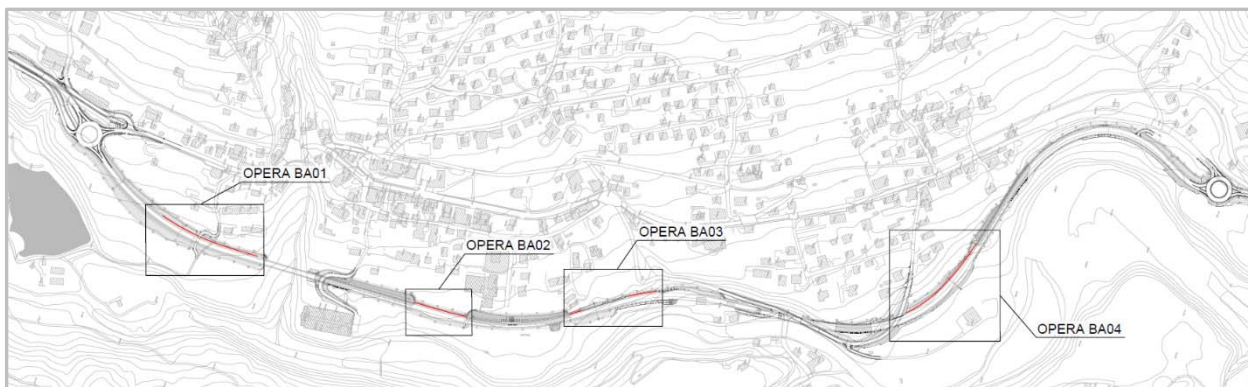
Planimetria generale con ubicazione delle barriere antirumore
